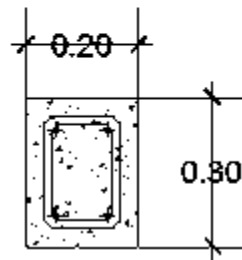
Detalle constructivo de la contra trabe. (Detalle elaborado por Karim Alan Corona Hernández).
